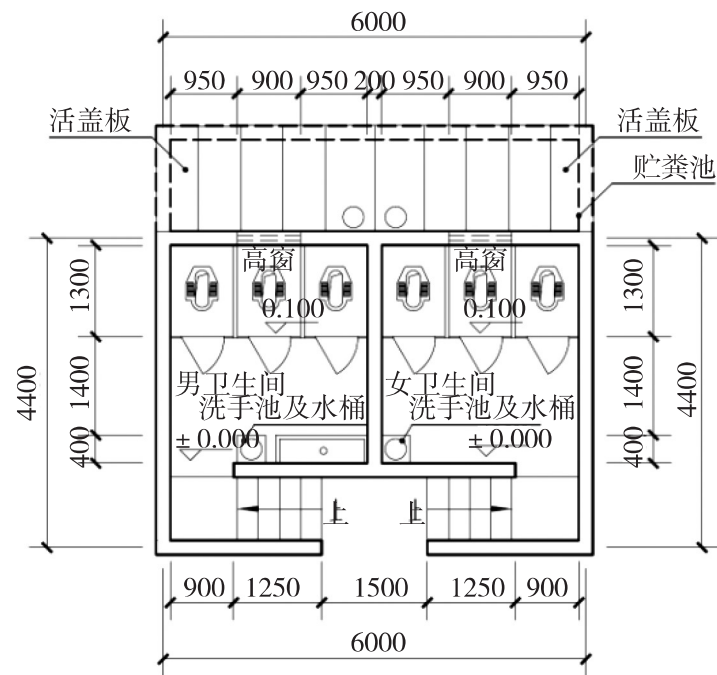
二类旱厕平面布局示意图（mm）
